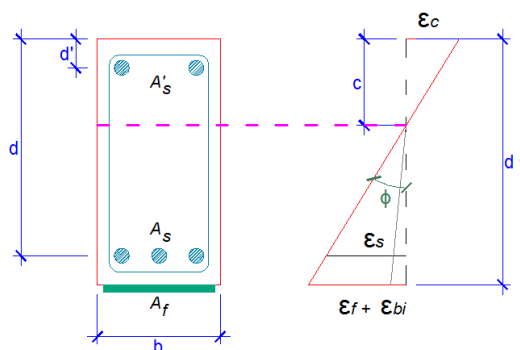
Viga de concreto armado externamente reforzada con FRP.
